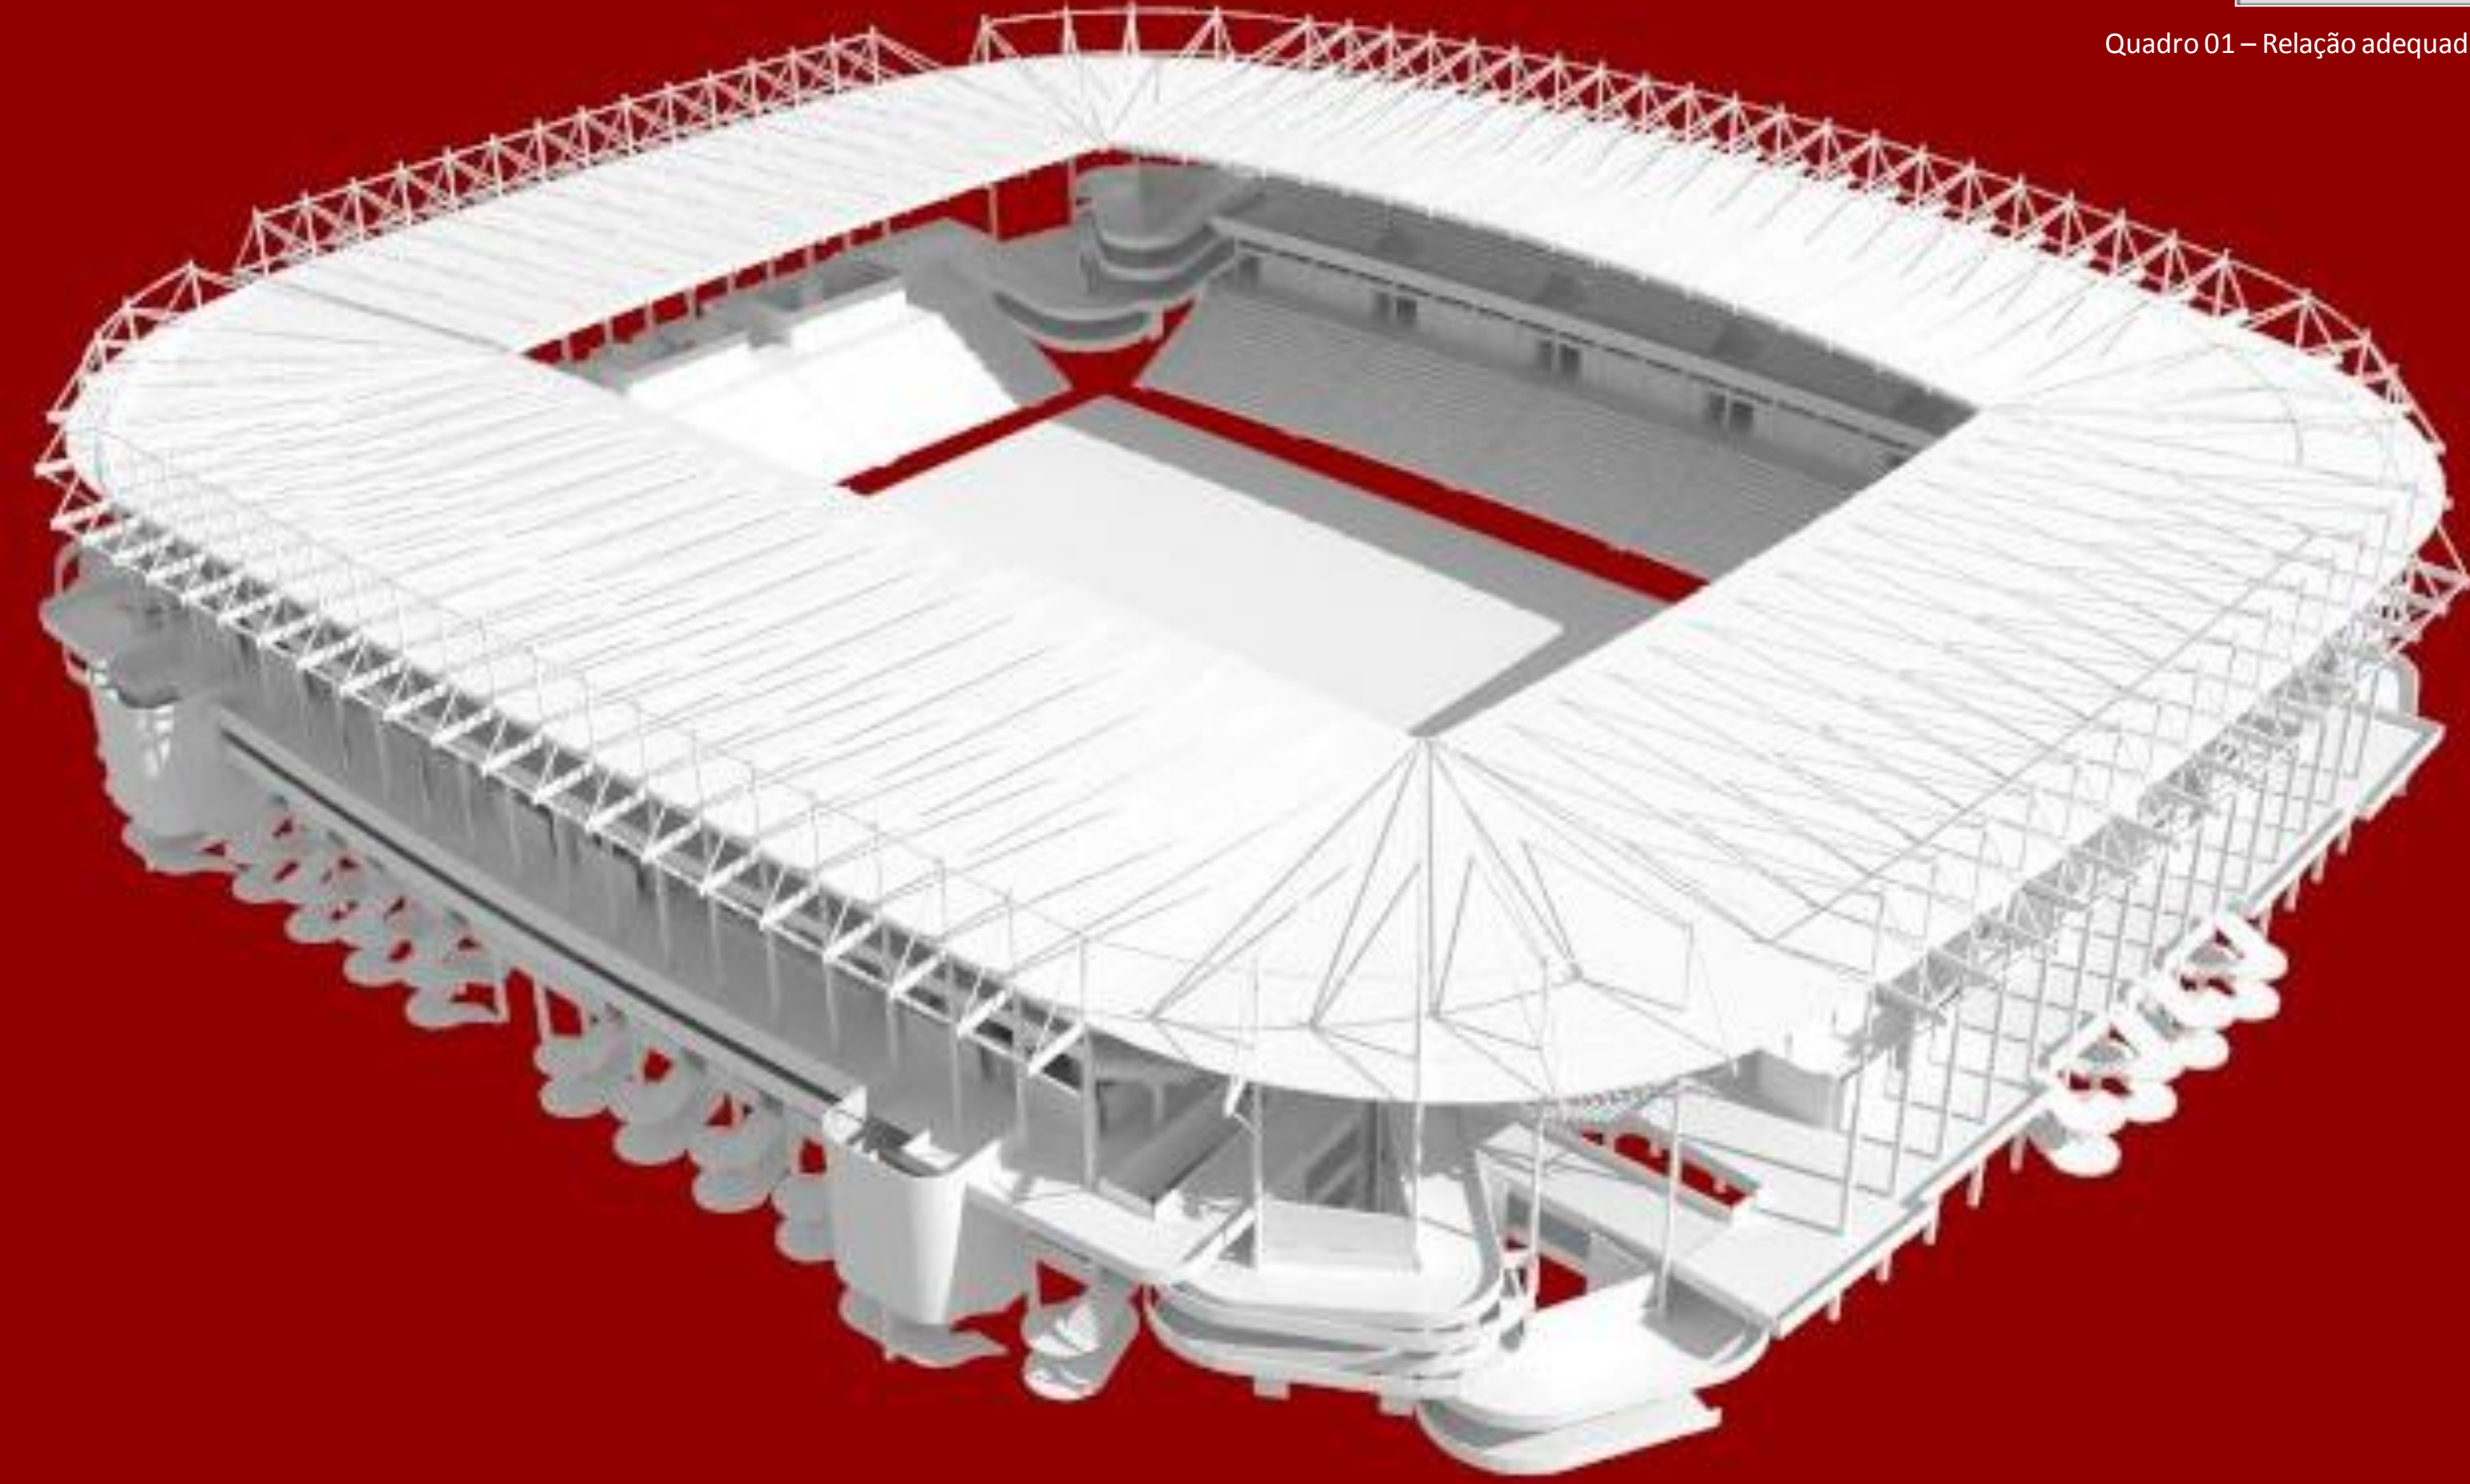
Modulação dos pavimentos de arquibancada foi determinante na concepção projetual (sem escala)
